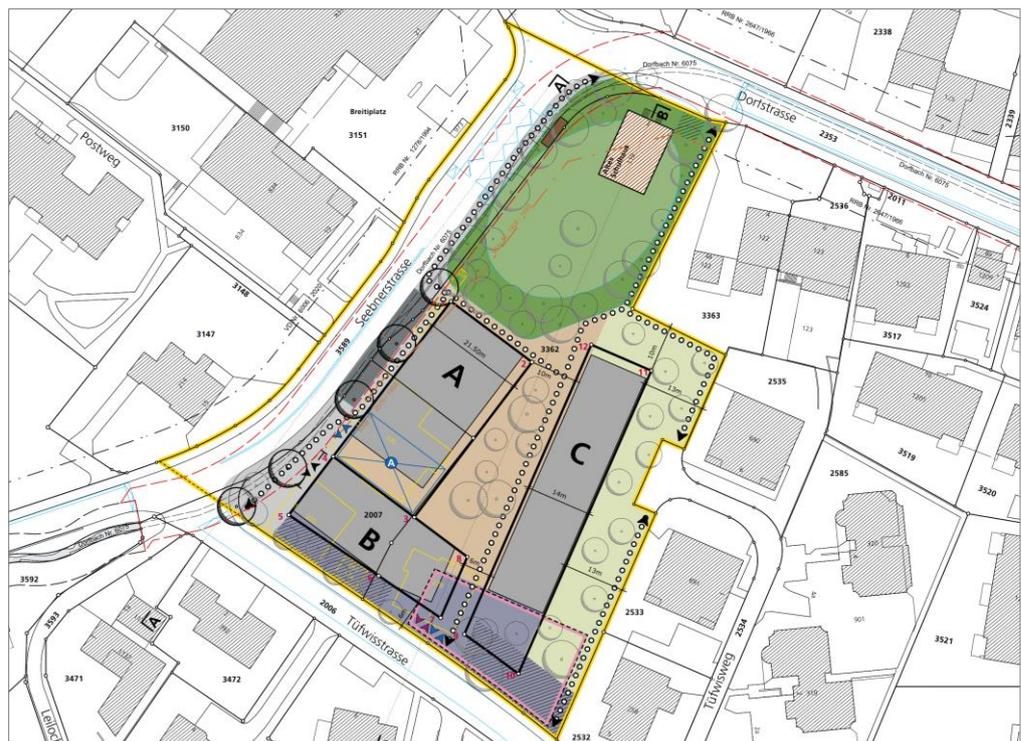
Ausschnitt aus dem Situationsplan des öffentlichen Gestaltungsplan Dorfzentrum Winkel (Stand: 12.12.2023)
